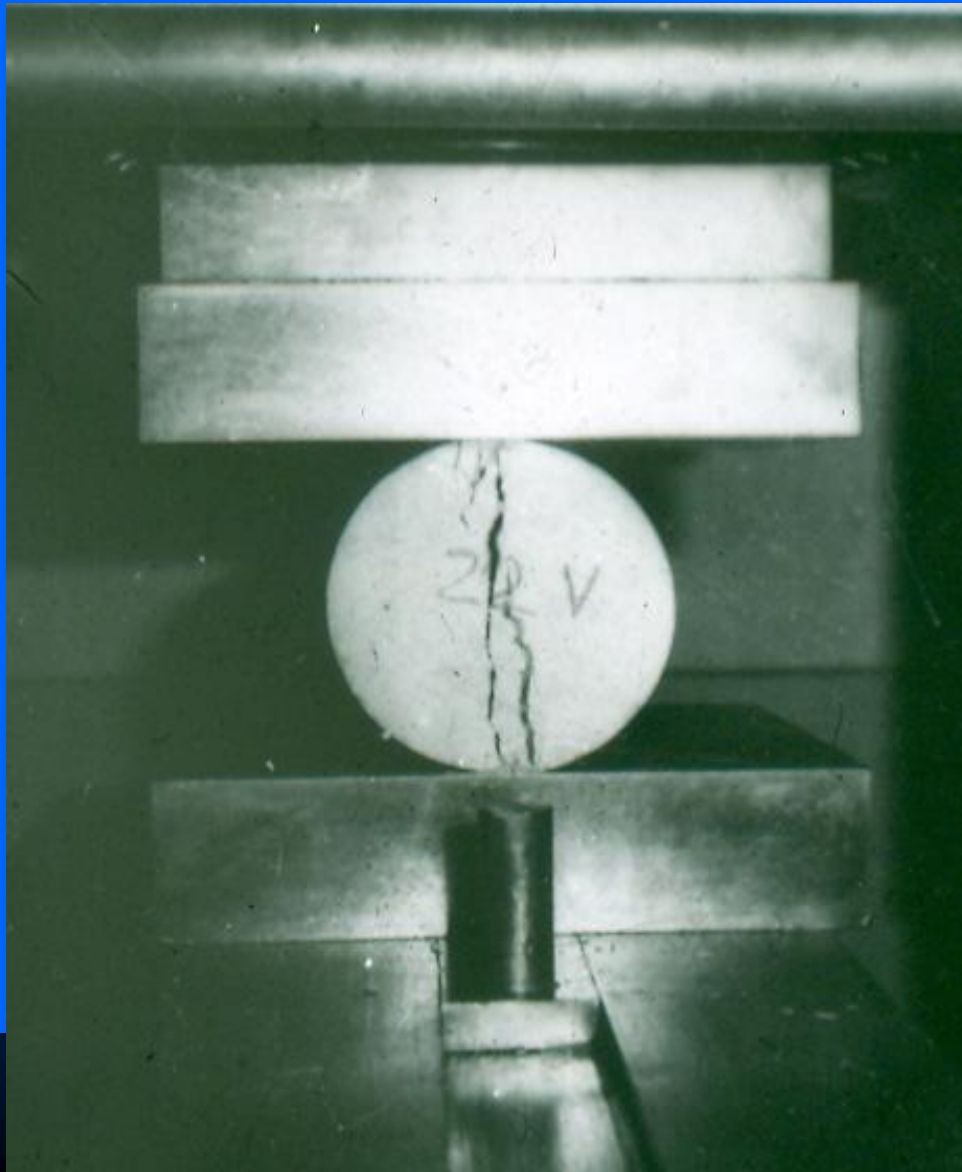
Ispitivanje čvrstoće betona pri zatezanju "cepanjem".
